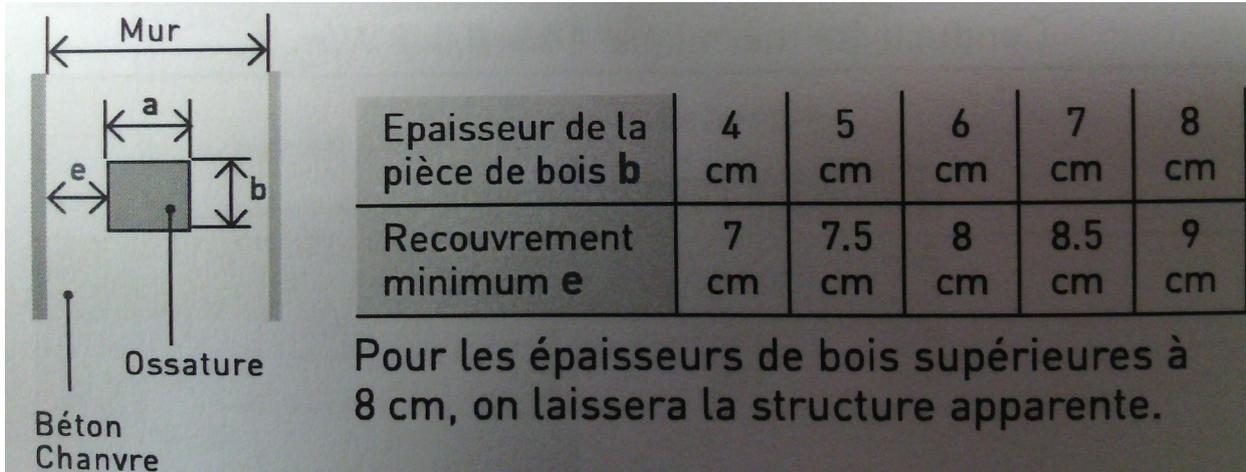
Coupe horizontale du mur ; épaisseur d'enrobage (e) et section de bois (a et b)
